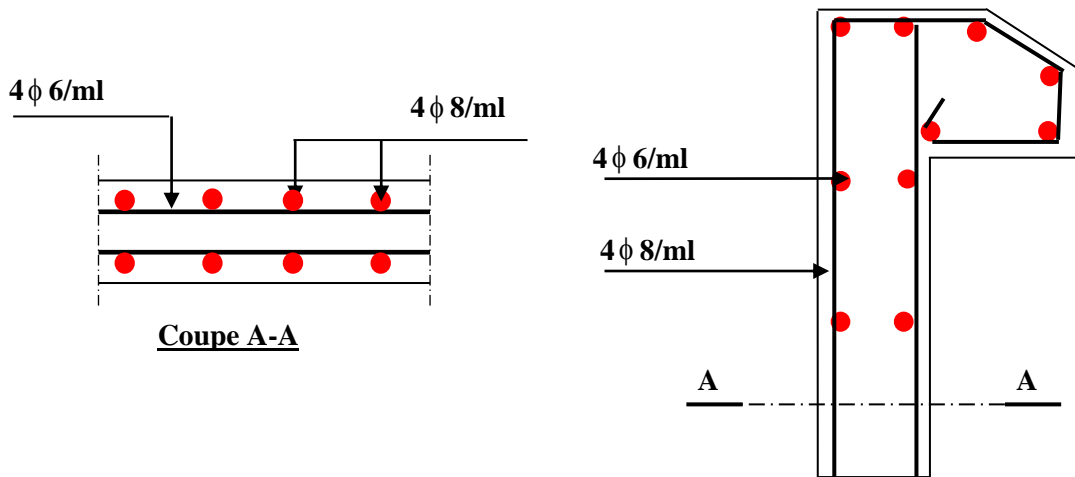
Schéma de ferrailage de l'acrotère (Terrasse inaccessible).
